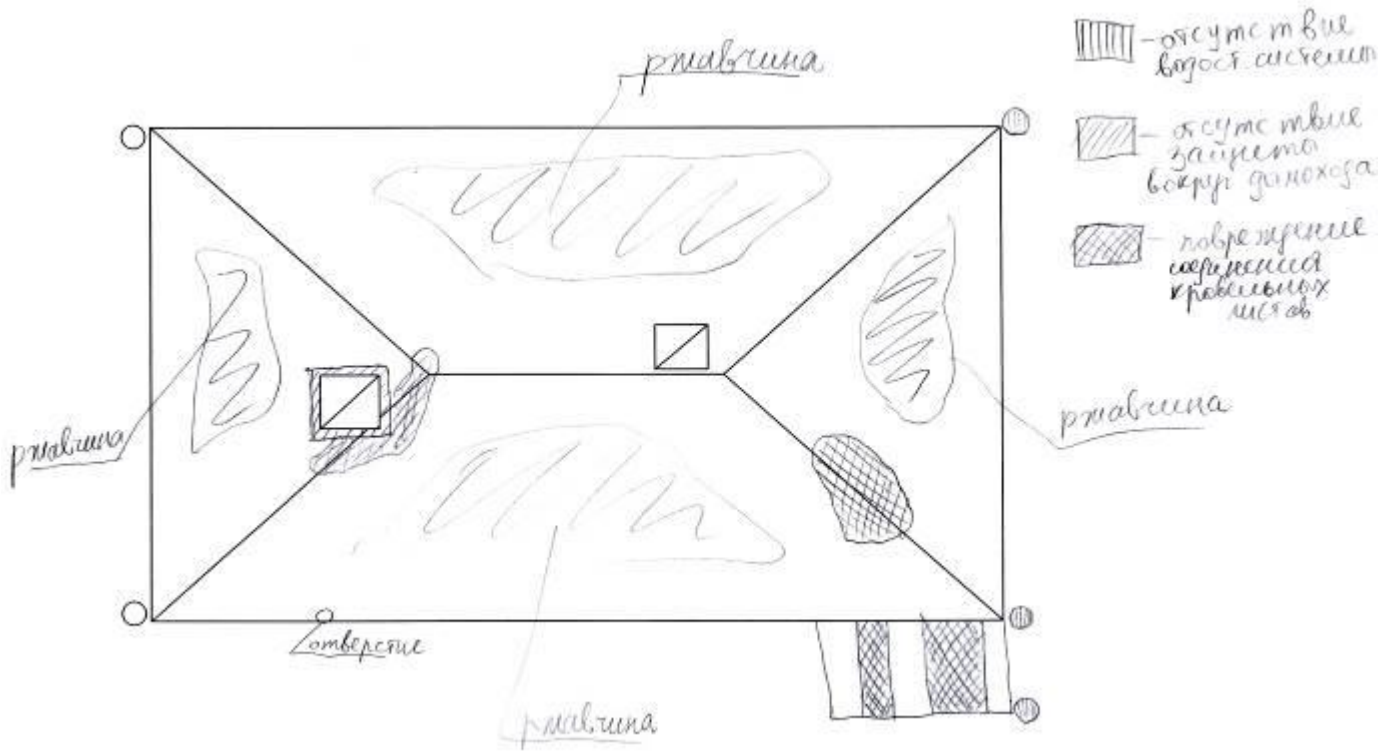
Дефектная карта кровли (здание рис.1,2).
